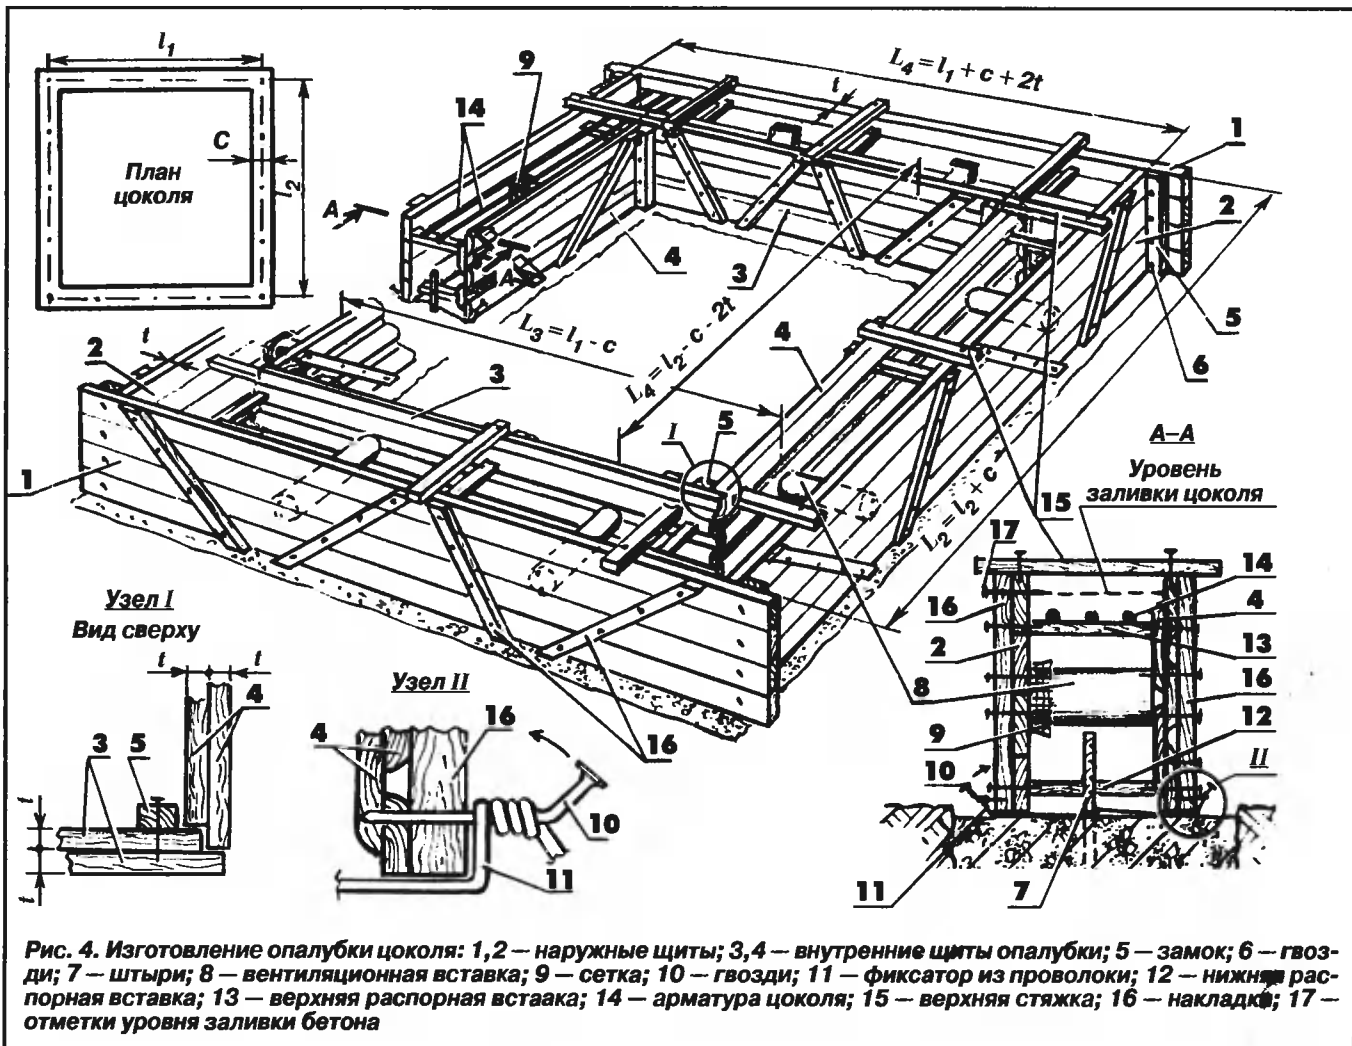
Изготовление опалубки цоколя: 1, 2 — наружные щиты; 3, 4 — внутренние щиты опалубки; 5 — замок; 6 — гвозди; 7 — штыри; 8 — вентиляционная вставка; 9 — сетка; 10 — гвозди; 11 — фиксатор из проволоки; 12 — нижняя распорная вставка; 13 — верхняя распорная вставка; 14 — арматура цоколя; 15 — верхняя стяжка; 16 — накладка; 17 — отметки уровня заливки бетона
